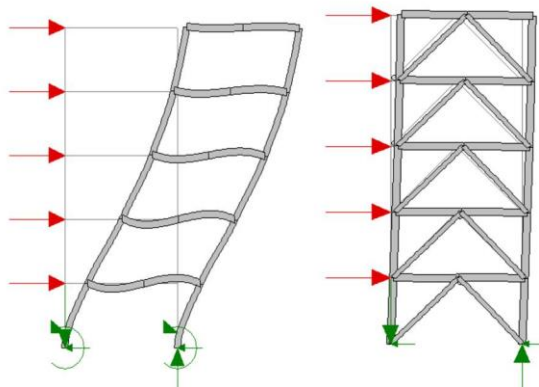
Travamento realizado pelo contraventamento (Carneiro, 2008)
